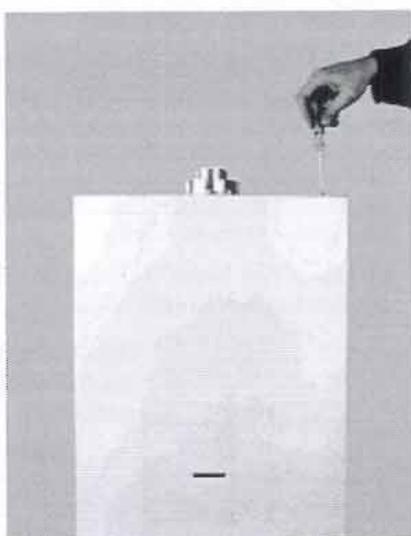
Løsn og fjern de 2 skruer, der fastholder kedlens øverste forplade foroven og fjern selve forpladen.
